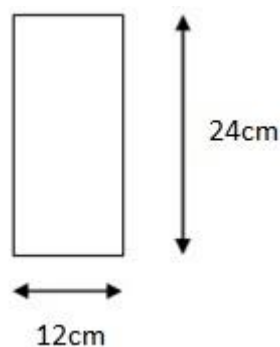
« Coupe schématique de la poutrelle (Appuis) »
